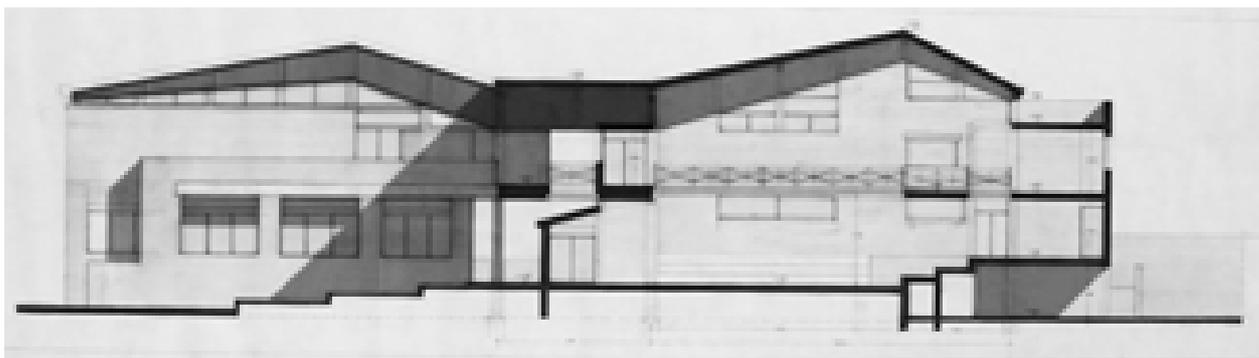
Sezione BB –08/12/1981 (AABS-1996.906)
